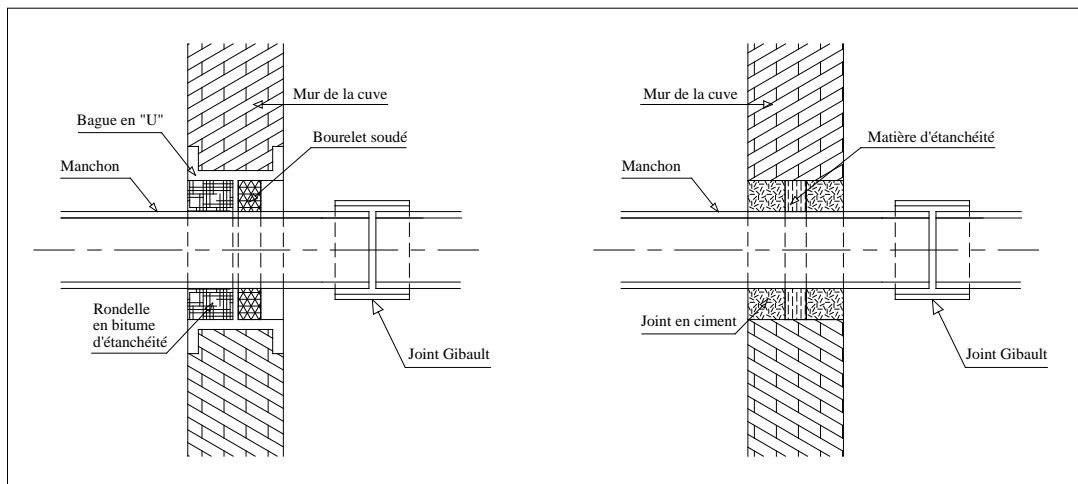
Traversée des conduites (manchon à bout lisse)
